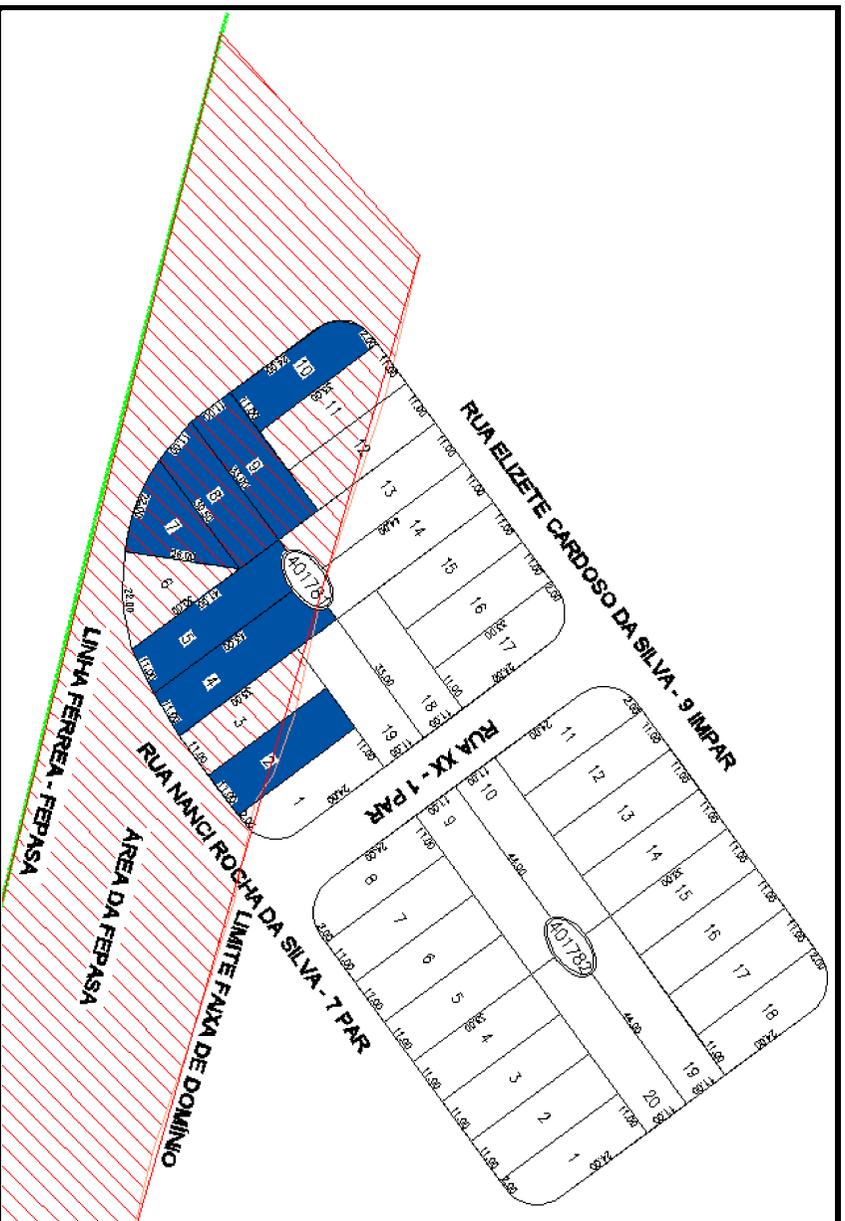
A faixa destacada com hachurais na cor vermelho mostra a localização dos lotes avaliando dentro da área da FEPASA, conforme mostrada nas fotos 01. e 02.
